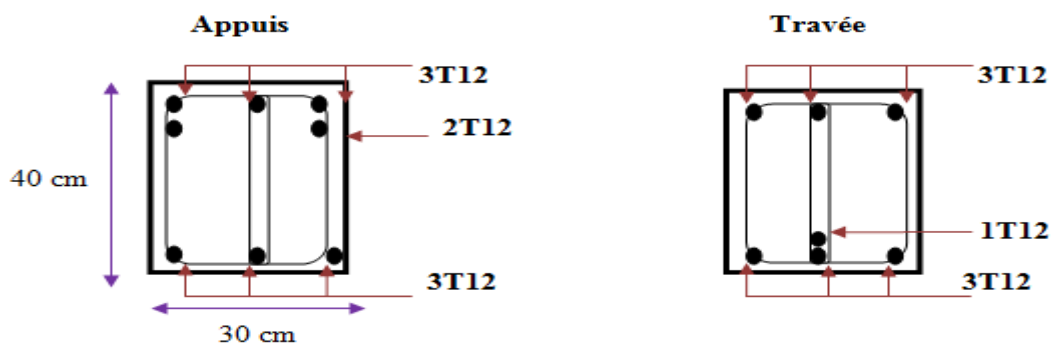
Schémas de ferrailage des poutres secondaire (30×40)
